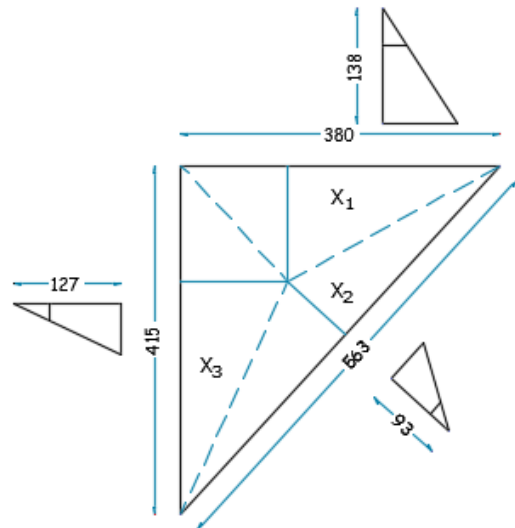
Dimension de la dalle pleine triangulaire.
